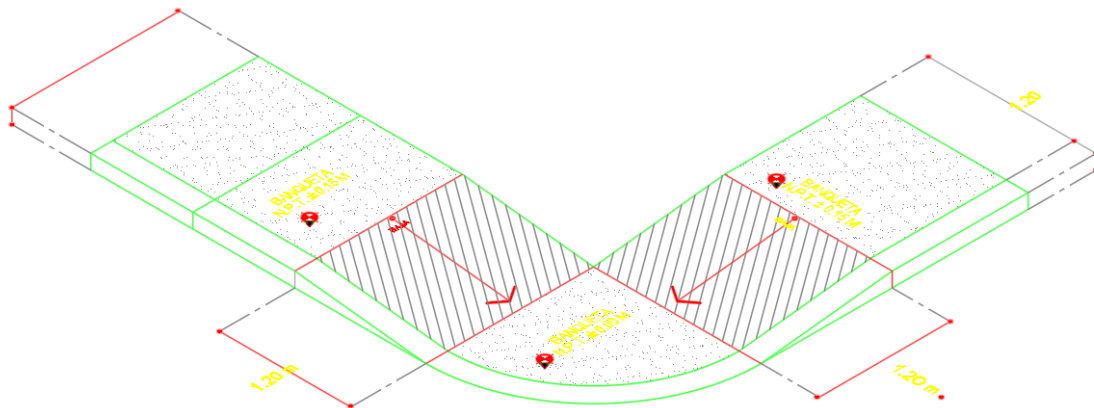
Detalle en planta de intersección vial en curva interna, mostrando el diseño de losas de pavimento rígido en concreto hidráulico, juntas de dilatación y dimensiones geométricas.
